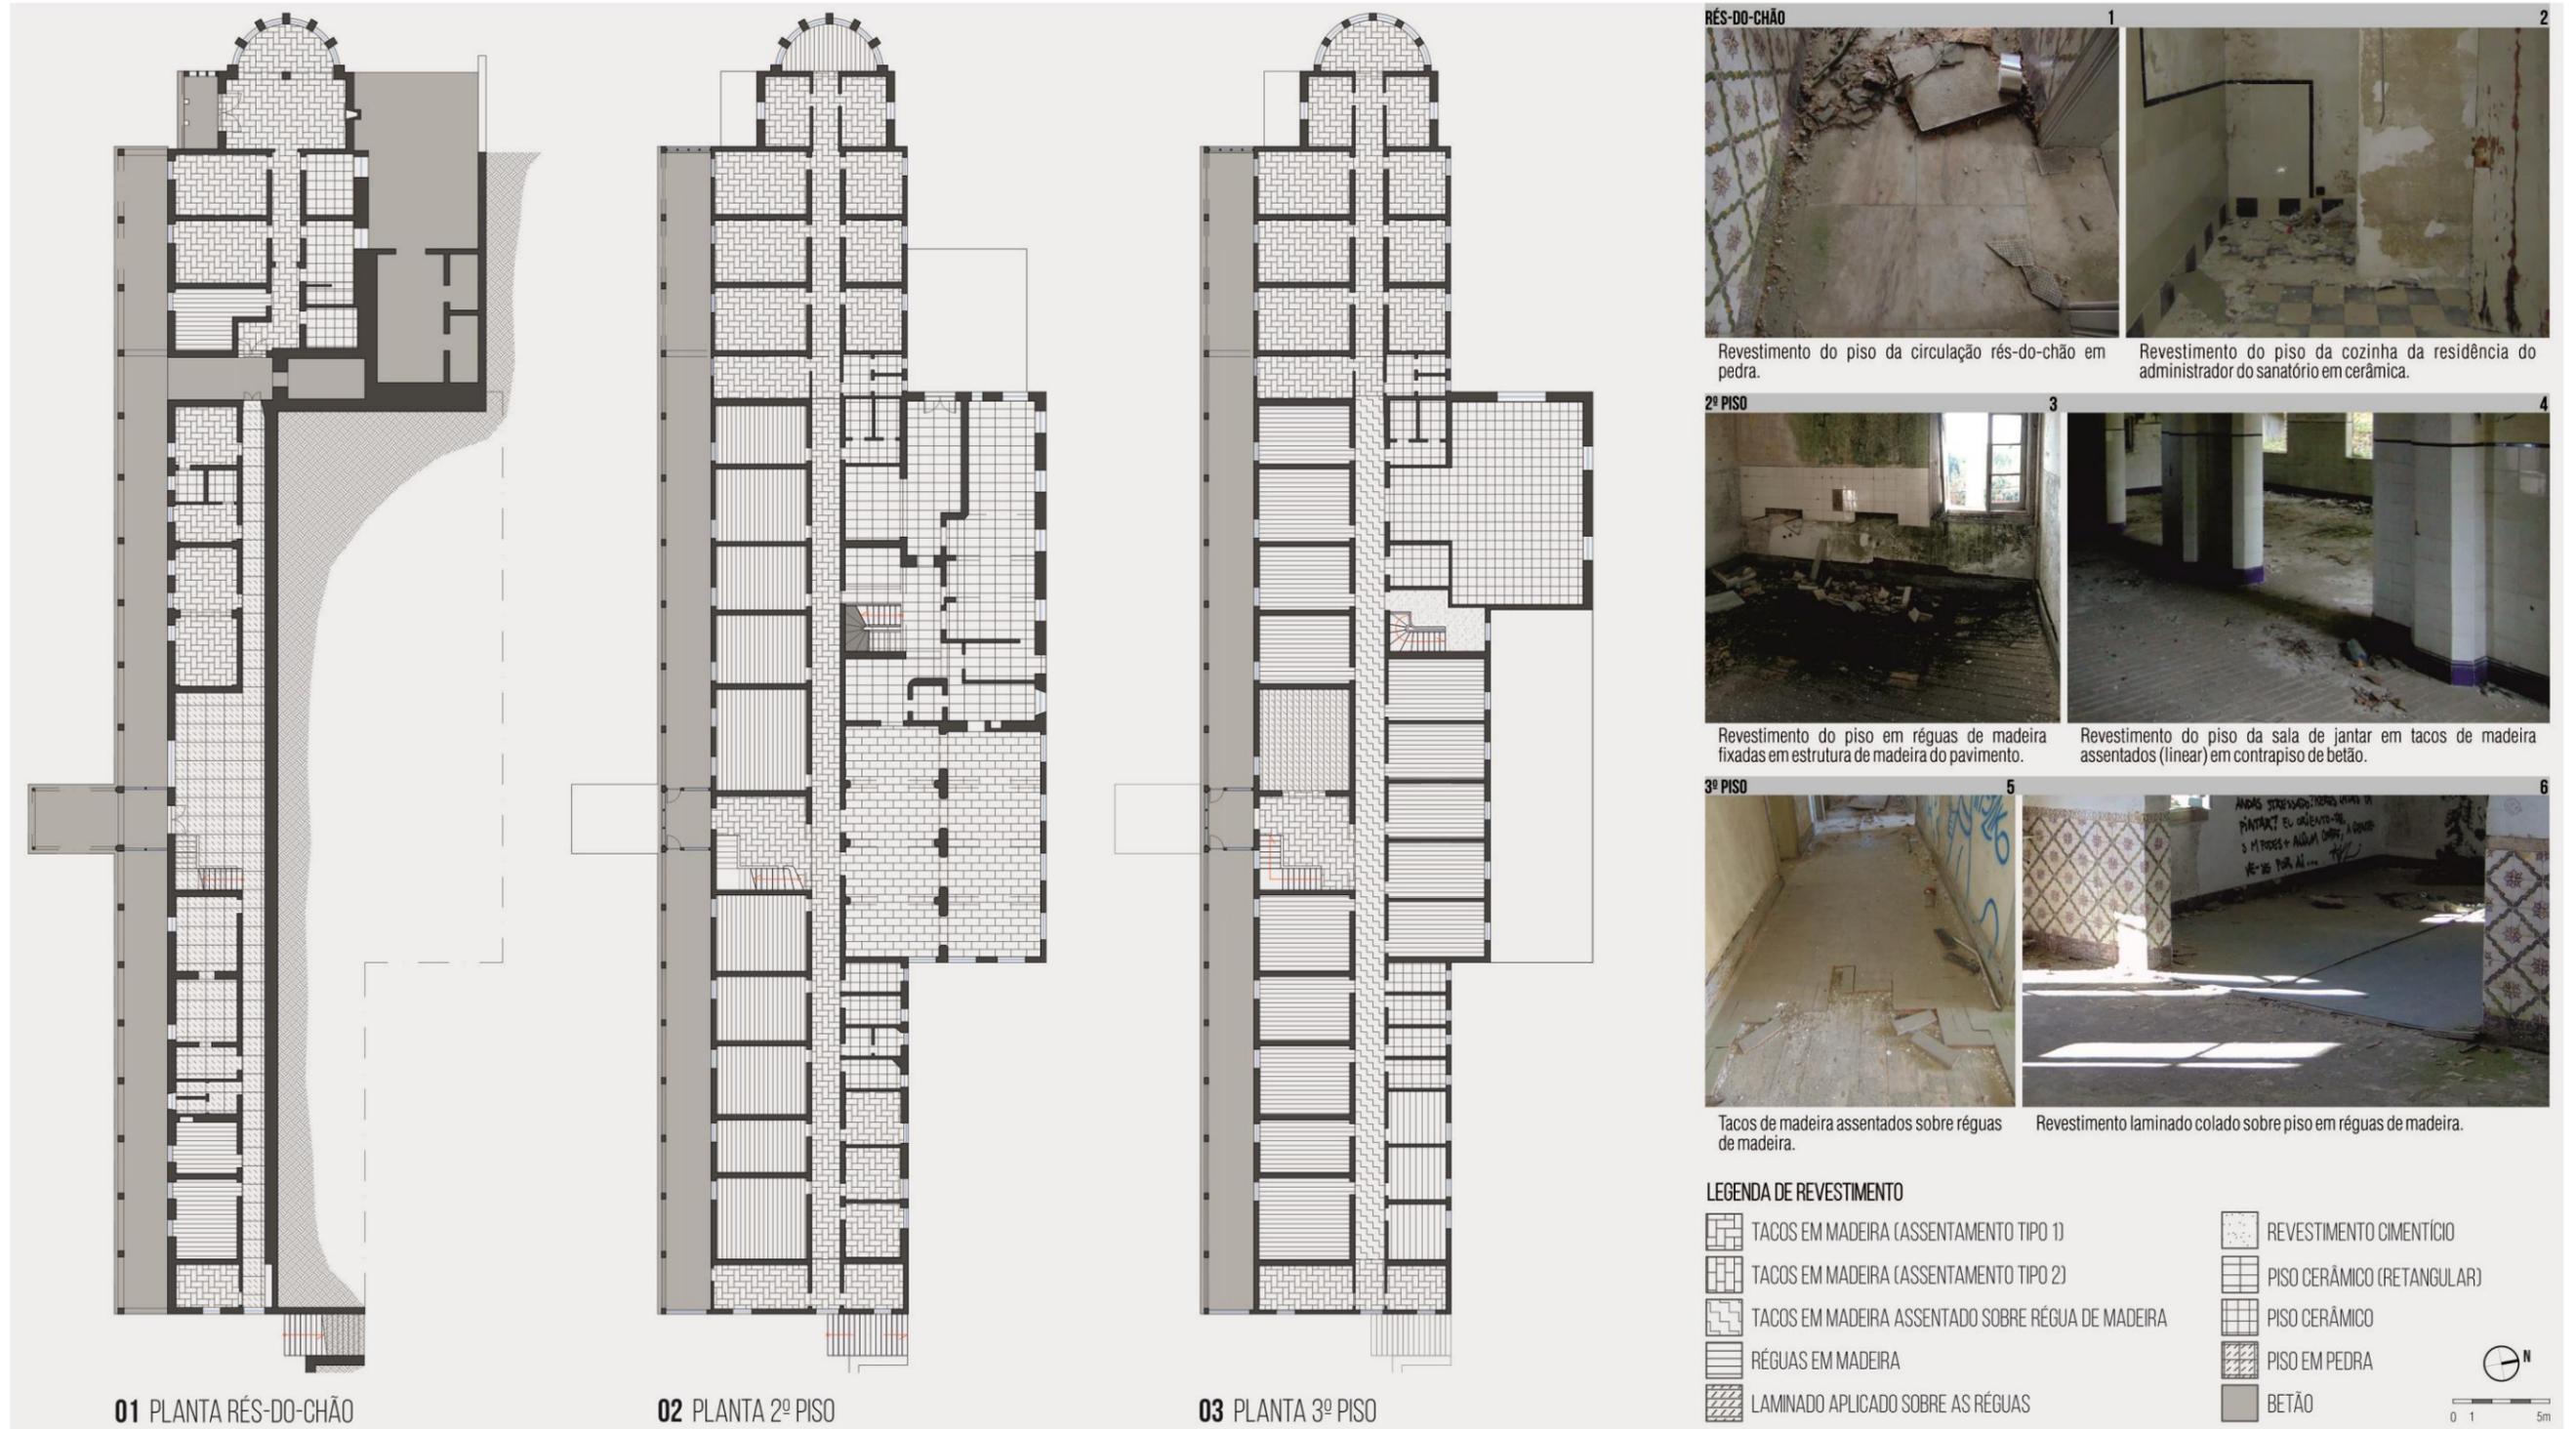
Definição Material – Plantas de revestimentos dos pavimentos e fotografias – rés-do-chão, 2º e 3º pisos (desenvolvida a partir do levantamento *in situ*).
